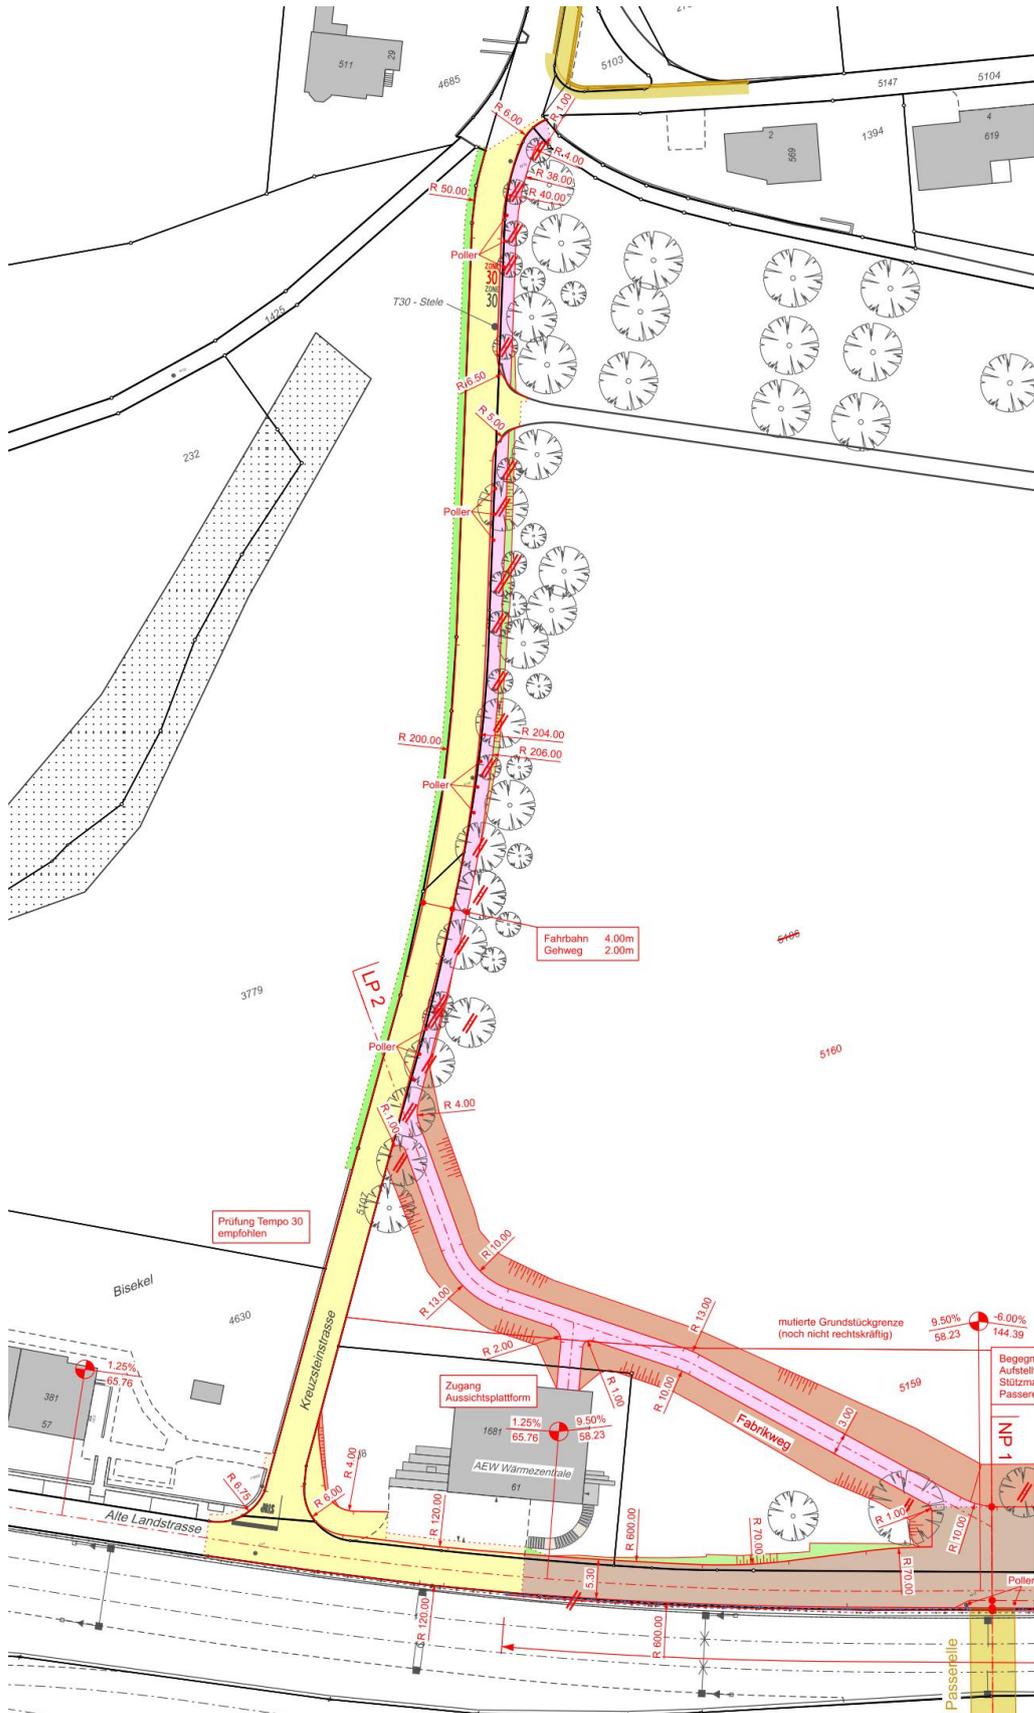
Gehweg entlang Kreuzsteinstrasse (Variante 2)
